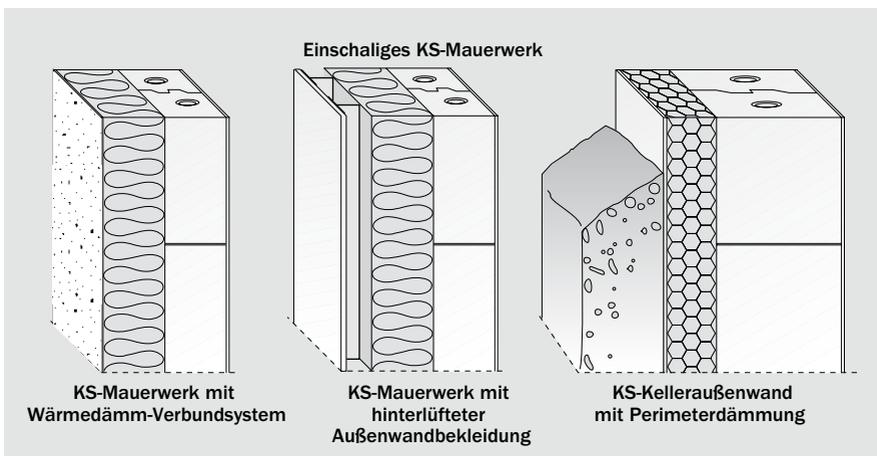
/19: Einschalige KS-Außenwandkonstruktionen für beheizte Gebäude
